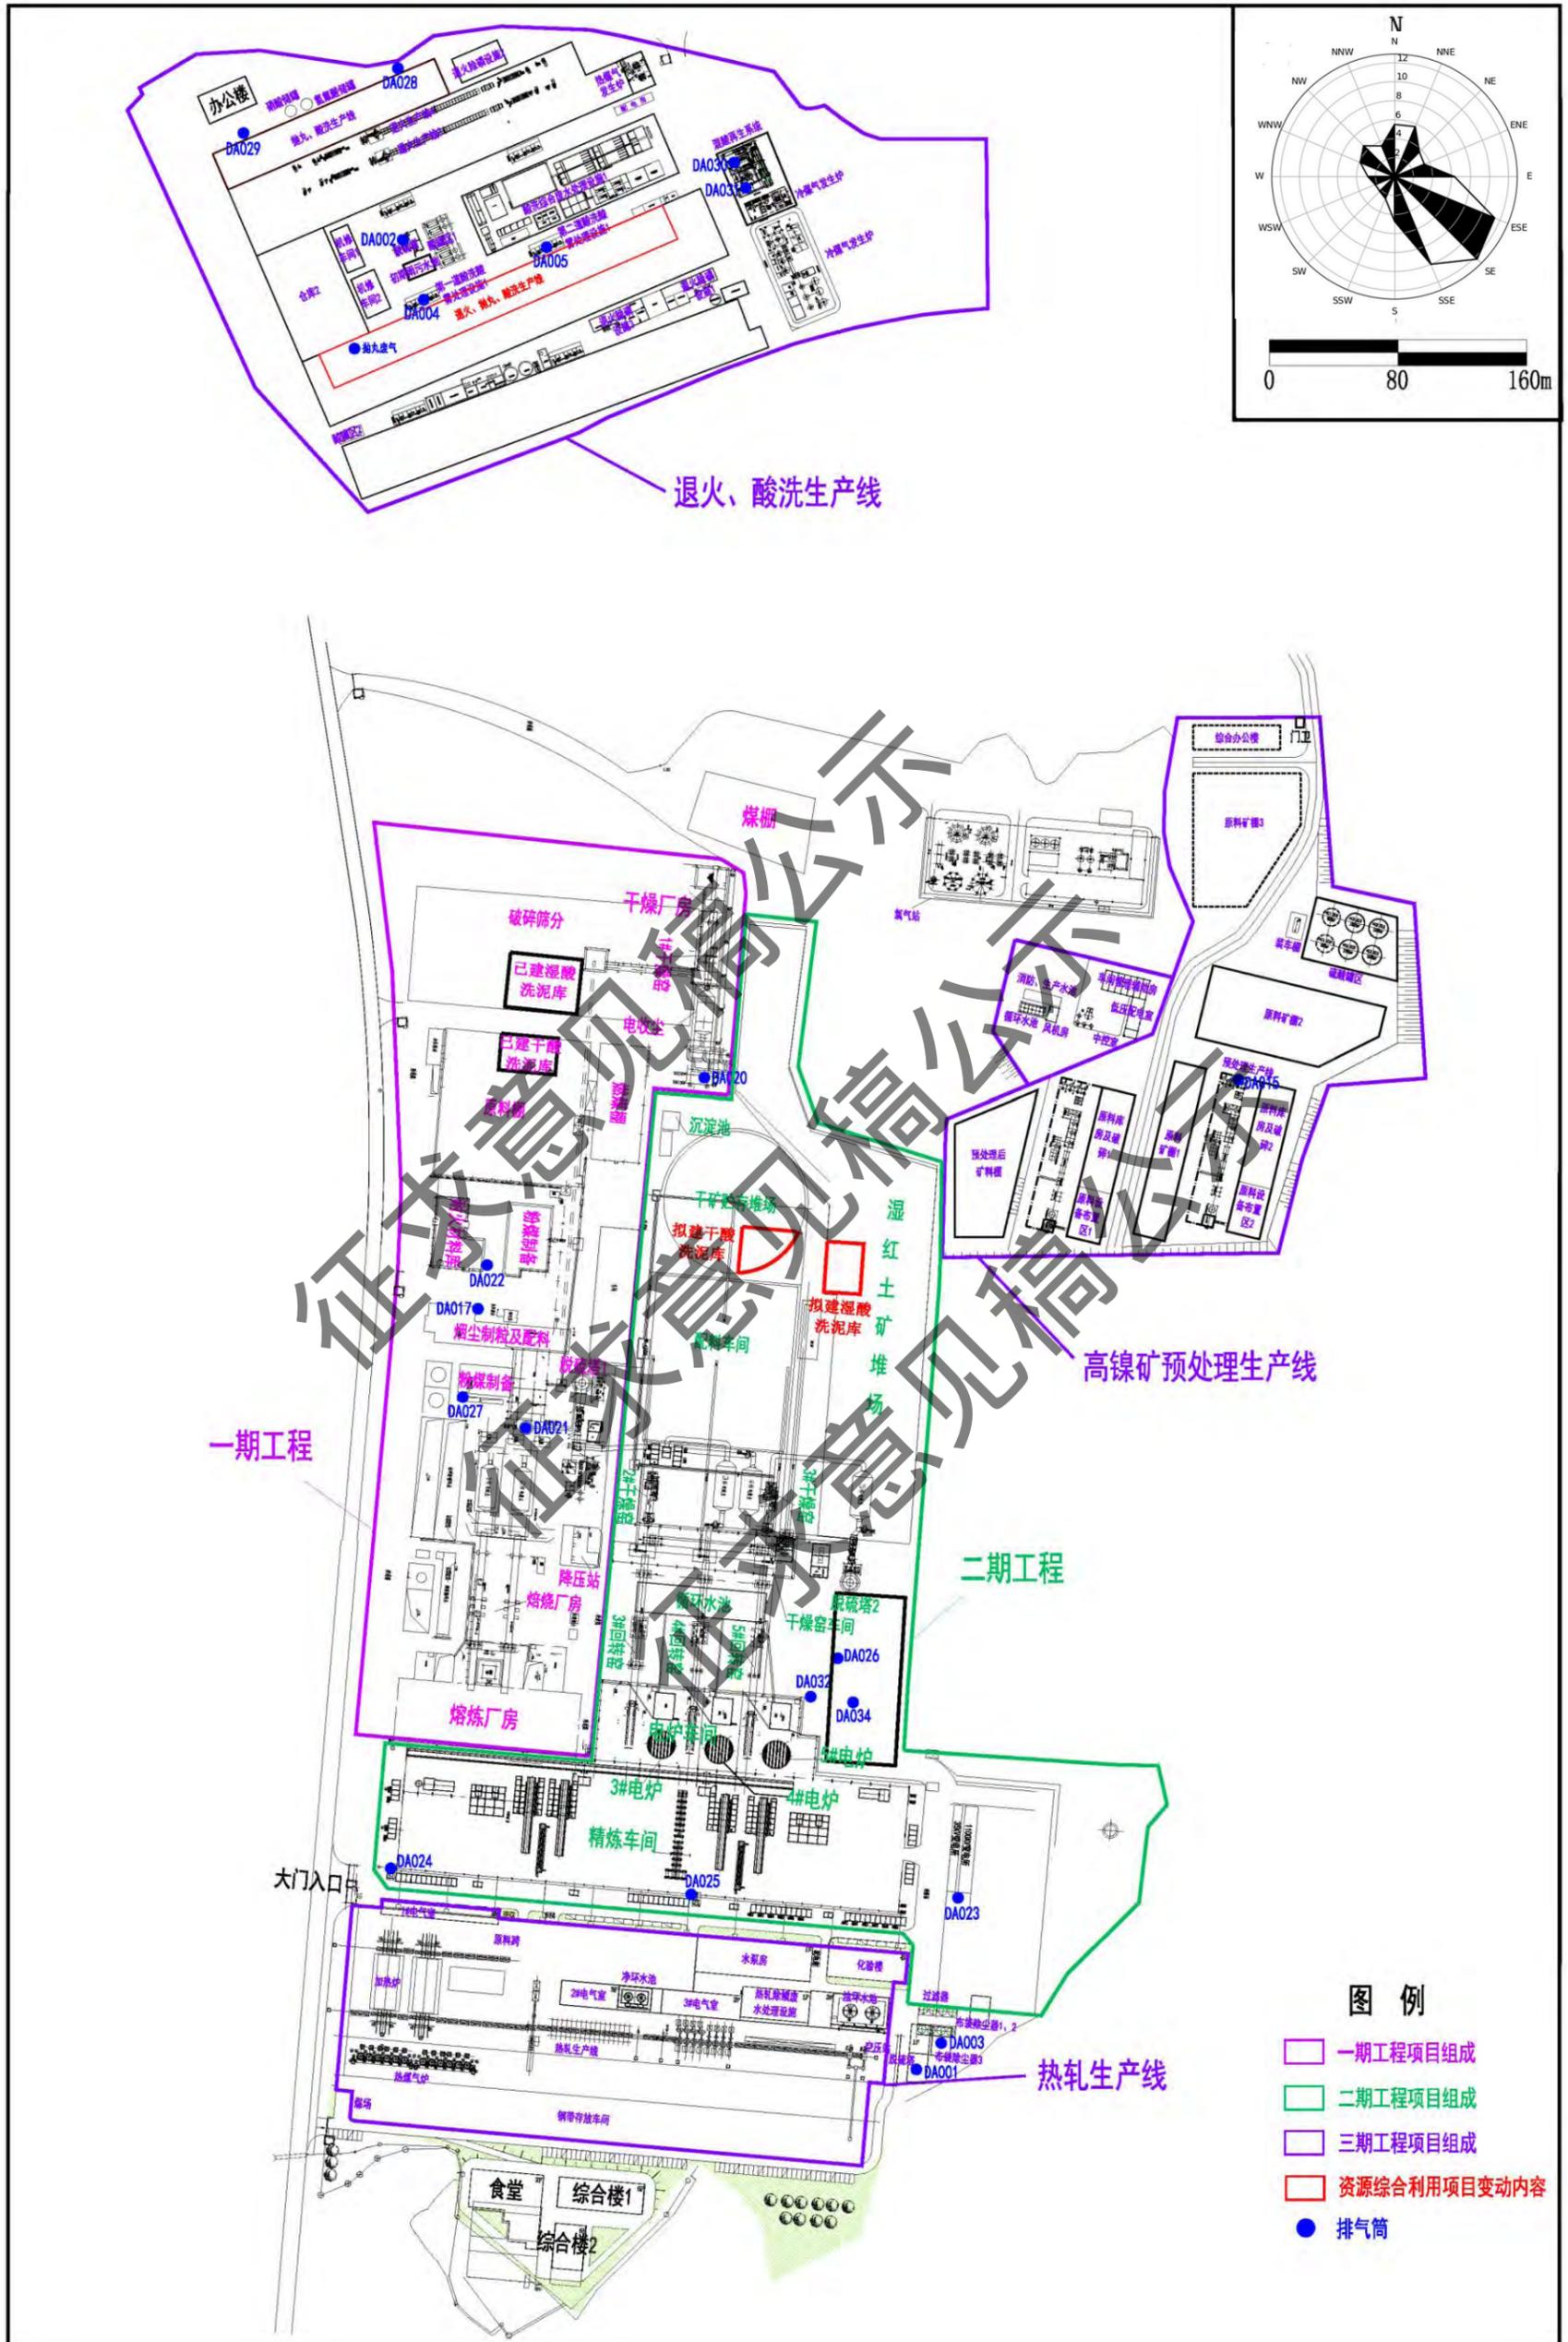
一期、二期、三期工程现状实际平面布置图
